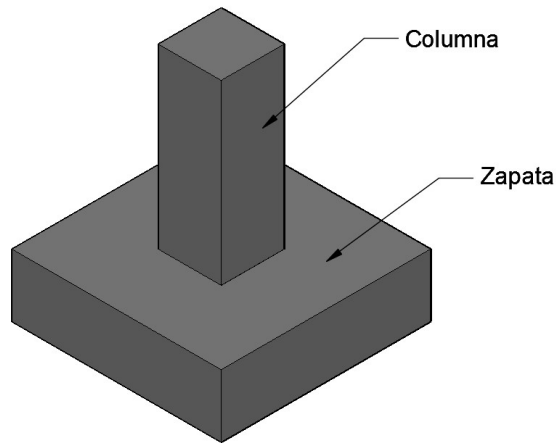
Gráfico 3D de una zapata con una columneta de hormigón armado
